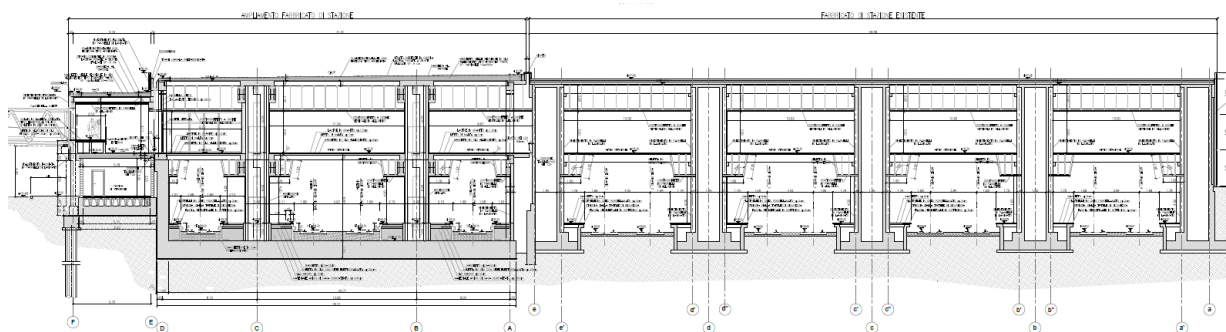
Sezione trasversale in corrispondenza del fabbricato di stazione.
